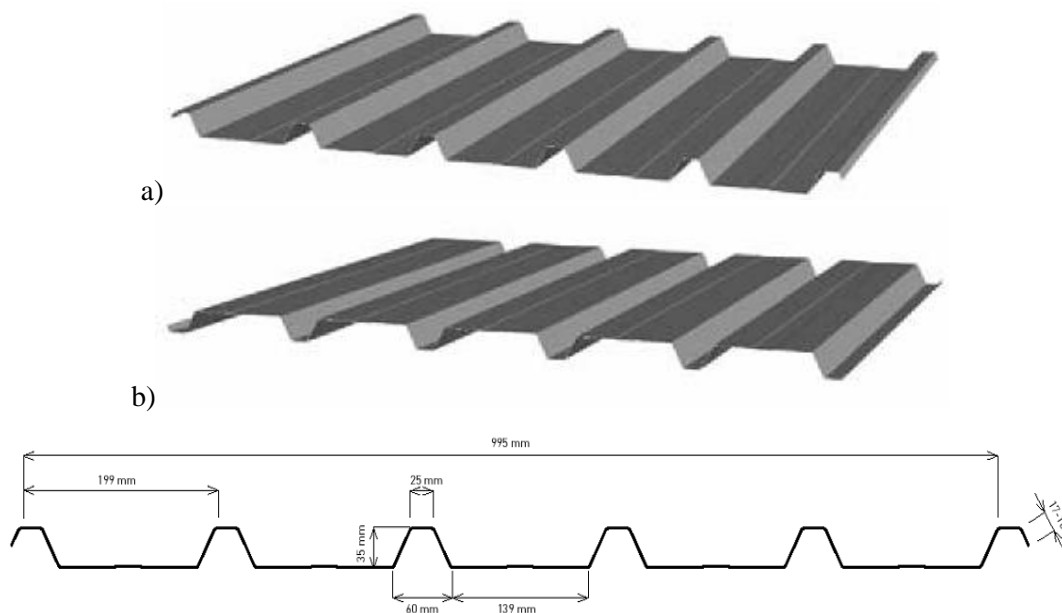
Chapa perfilada modelo TR35/995: a) Posição A, b) Posição B [81].
